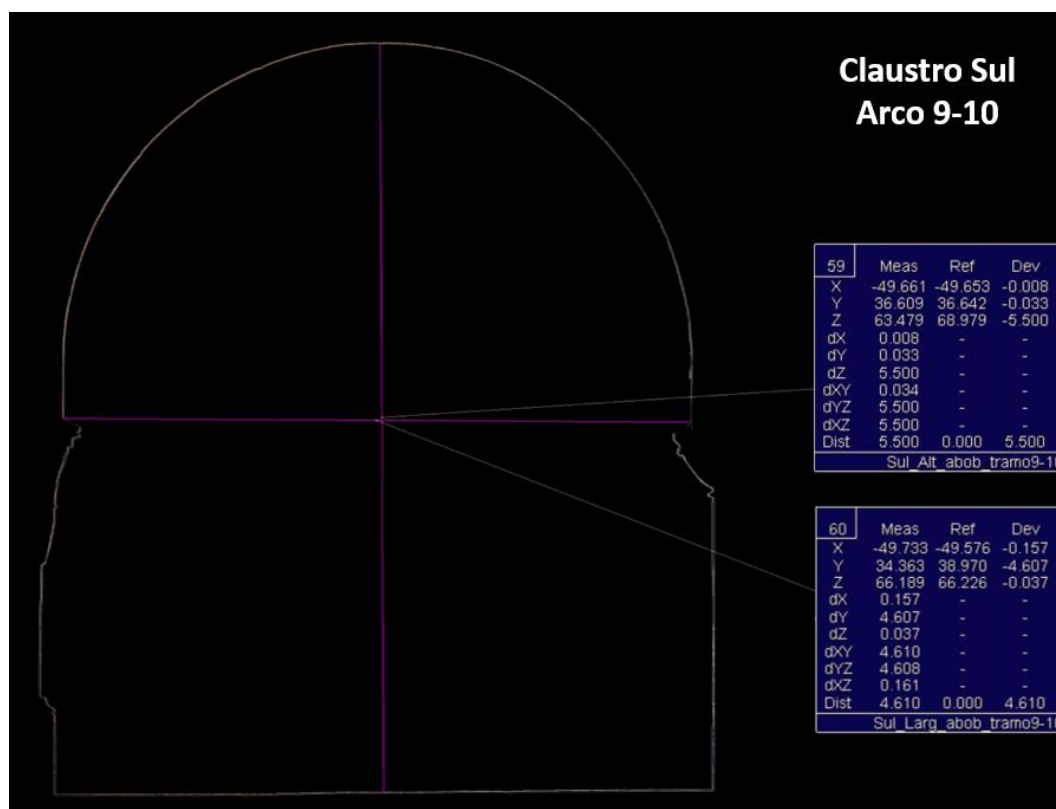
Corte transversal do Arco 9-10 do claustro Sul de D. Dinis.
